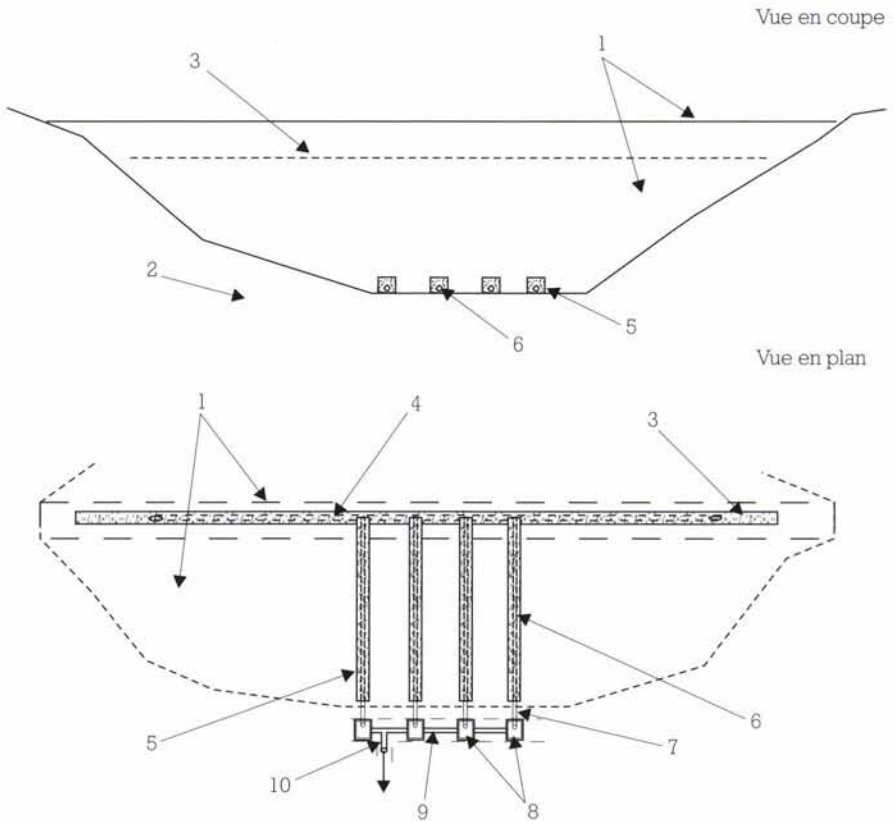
Schéma de principe d'un dispositif drainant simplifié dans le cas d'une fondation imperméable.
